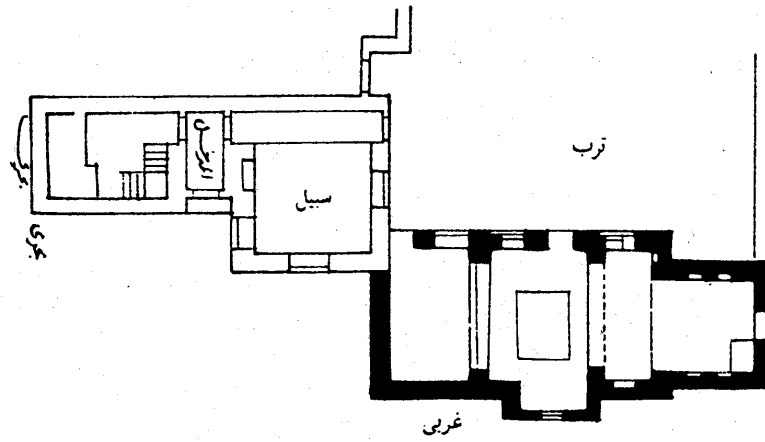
مسقط أفقي للقبّة الملحقة
